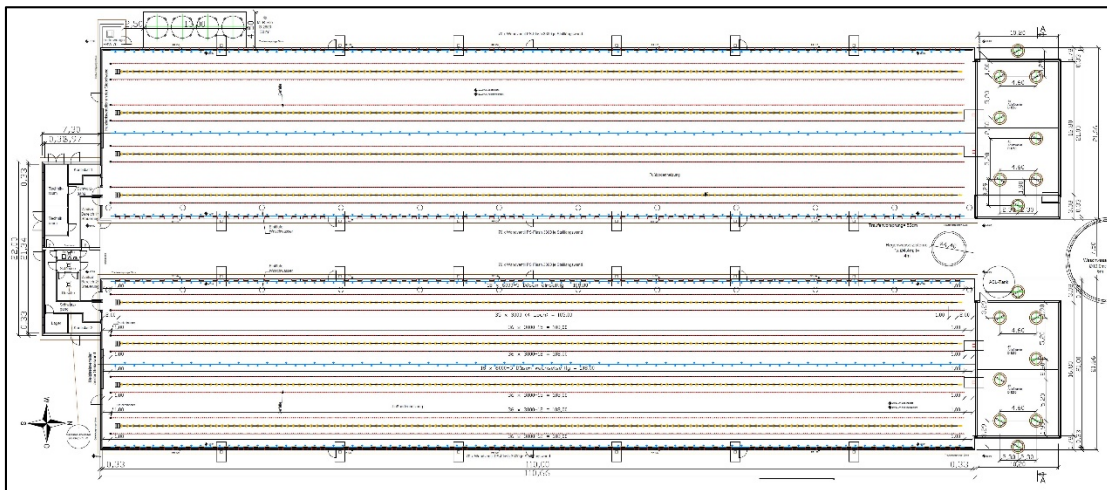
Ausschnitt aus den Planunterlagen, Grundrisse MHS 4 und MHS 5
